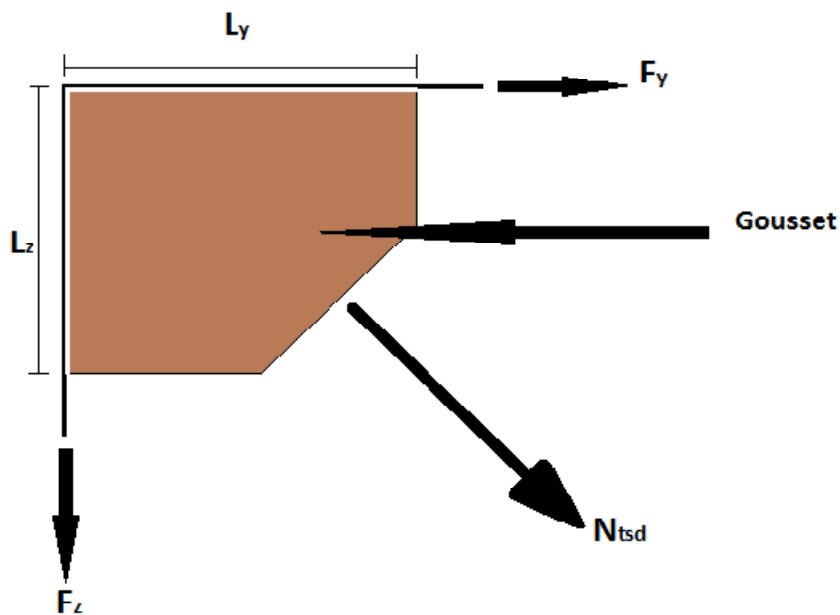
Assemblage gousset nœud du portique par cordon de soudure.
